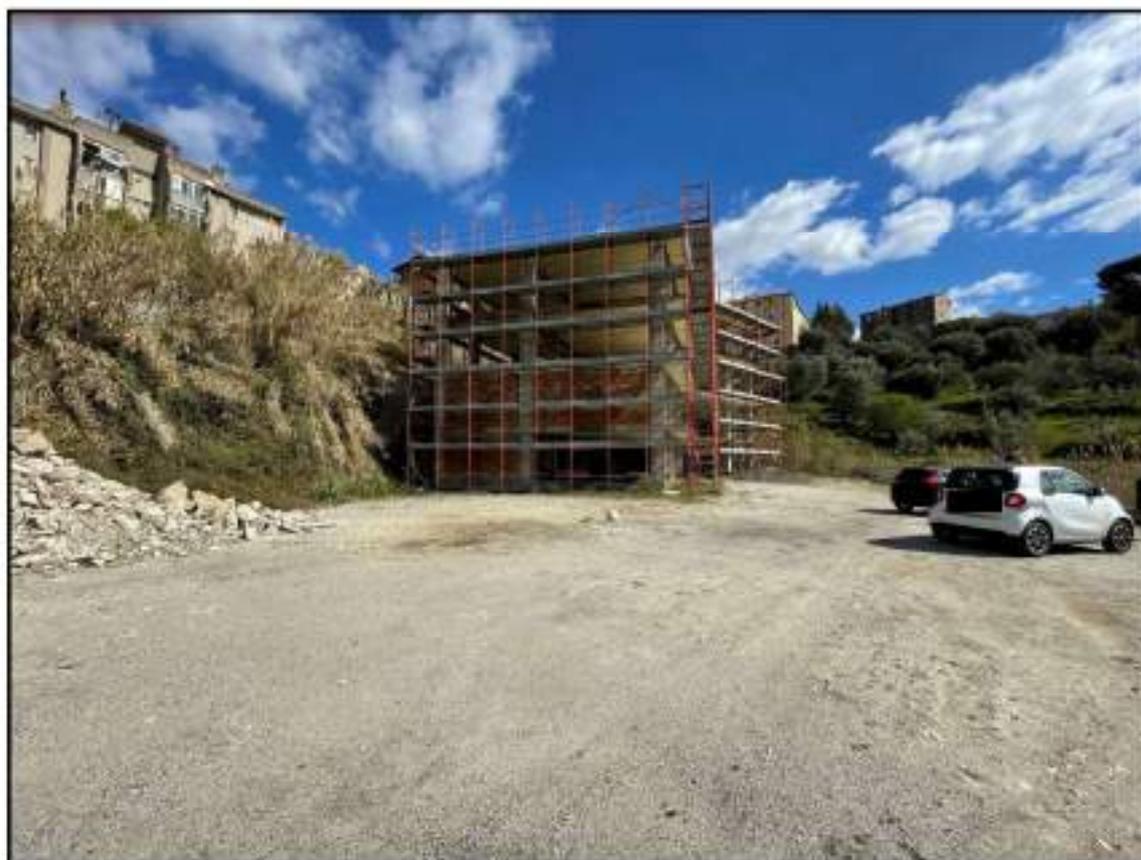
Vista del piazzale su cui insiste il fabbricato non ultimato
